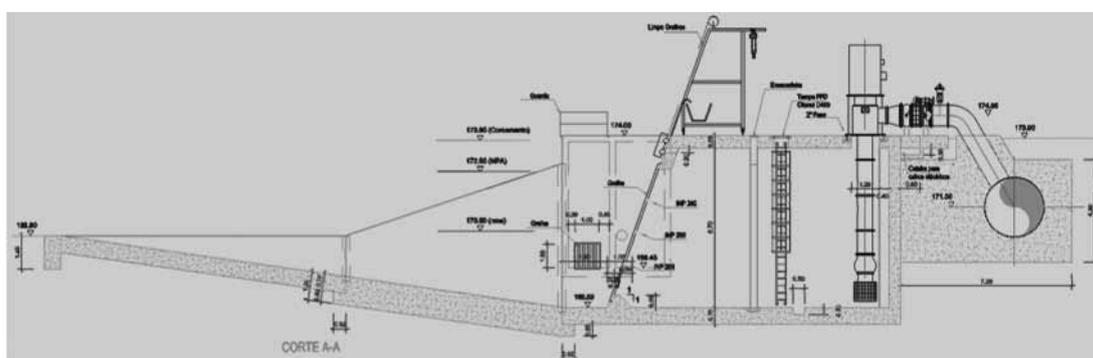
Estação Elevatória do Álamo .Perfil Transversal
